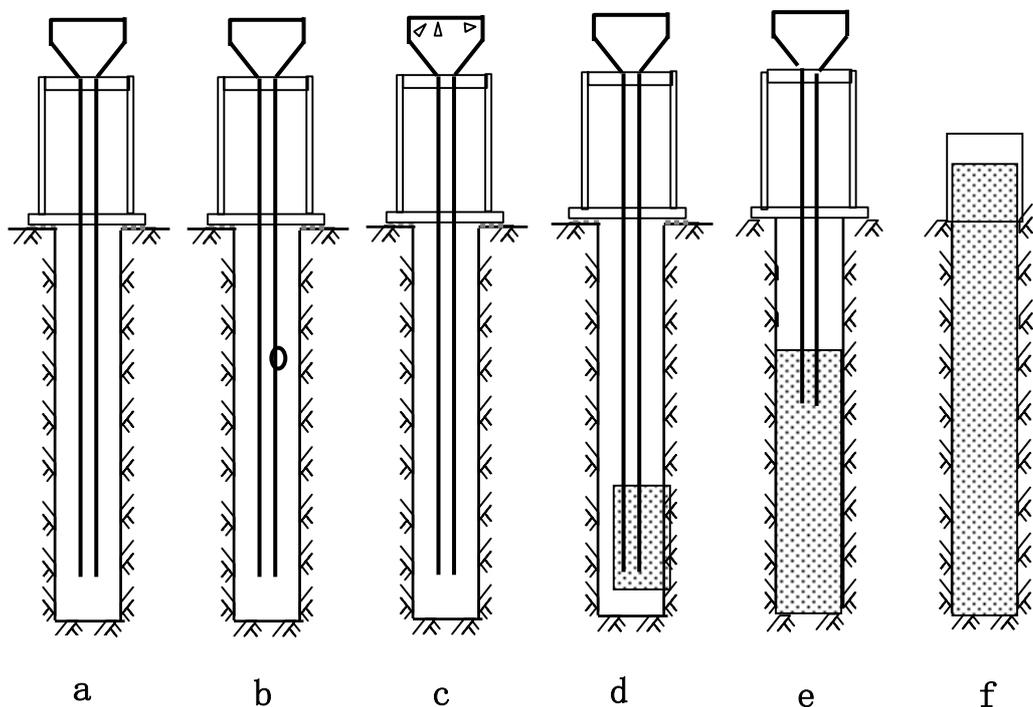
钻孔灌注桩水下混凝土灌注过程示意图
